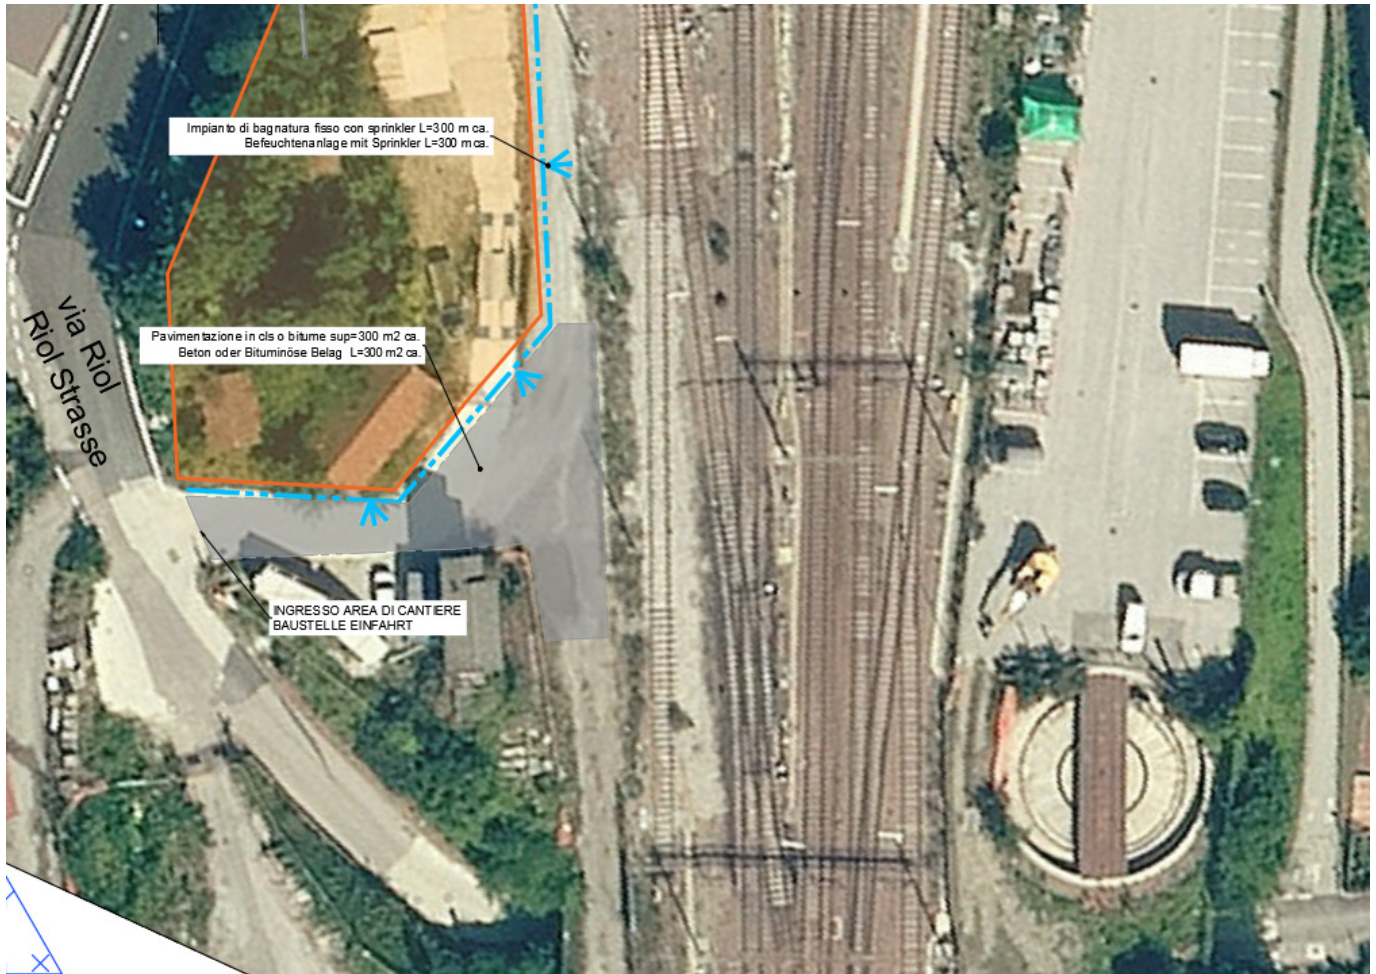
Staubminderungsmaßnahmen beim Baustelleneingangsbereich
